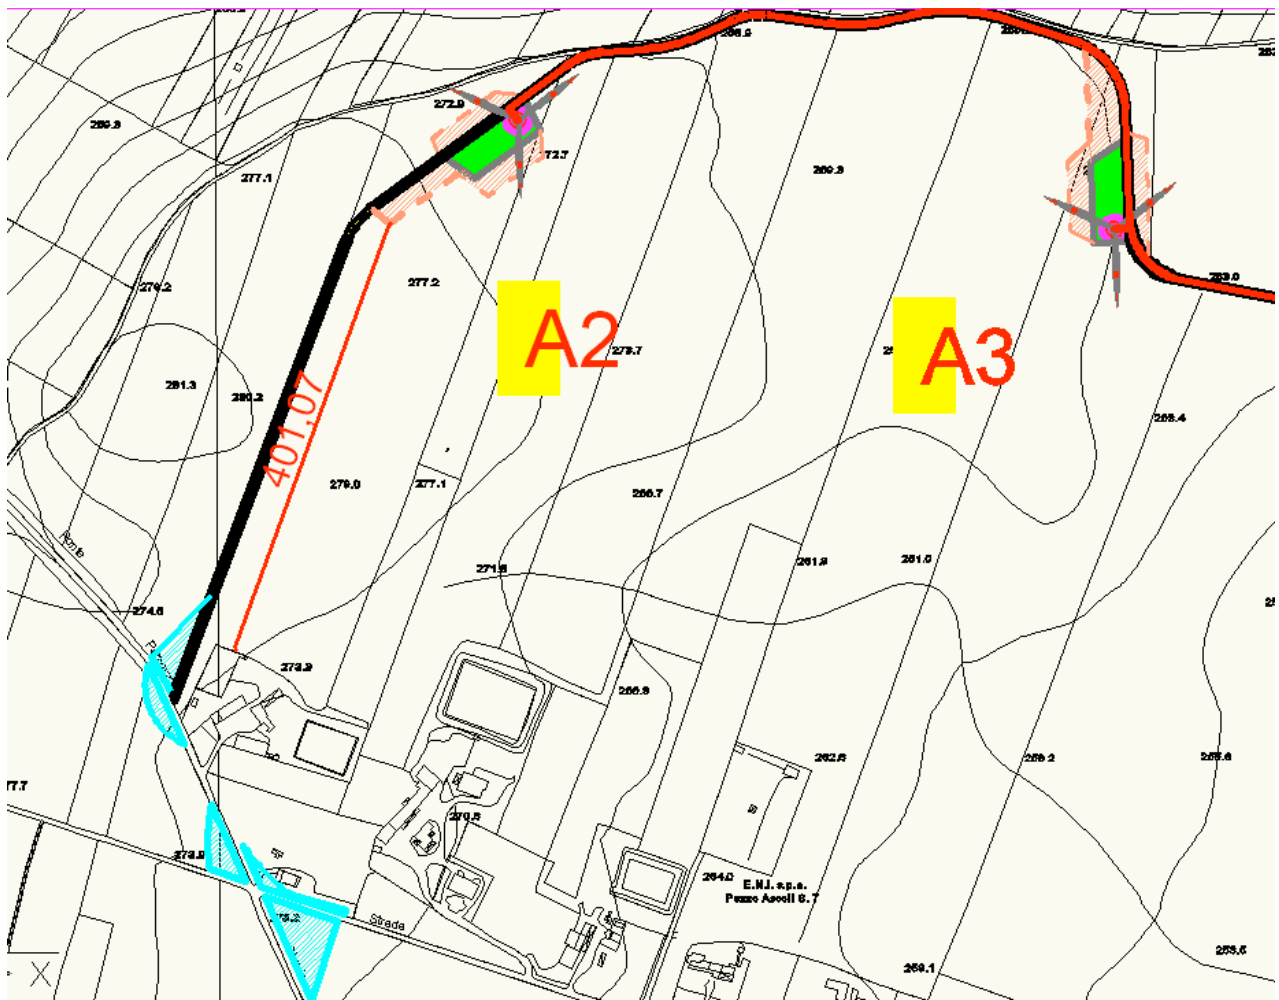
Inquadramento delle zone cantiere più importanti dal punto di vista vibrazionale del progetto nell'area.
